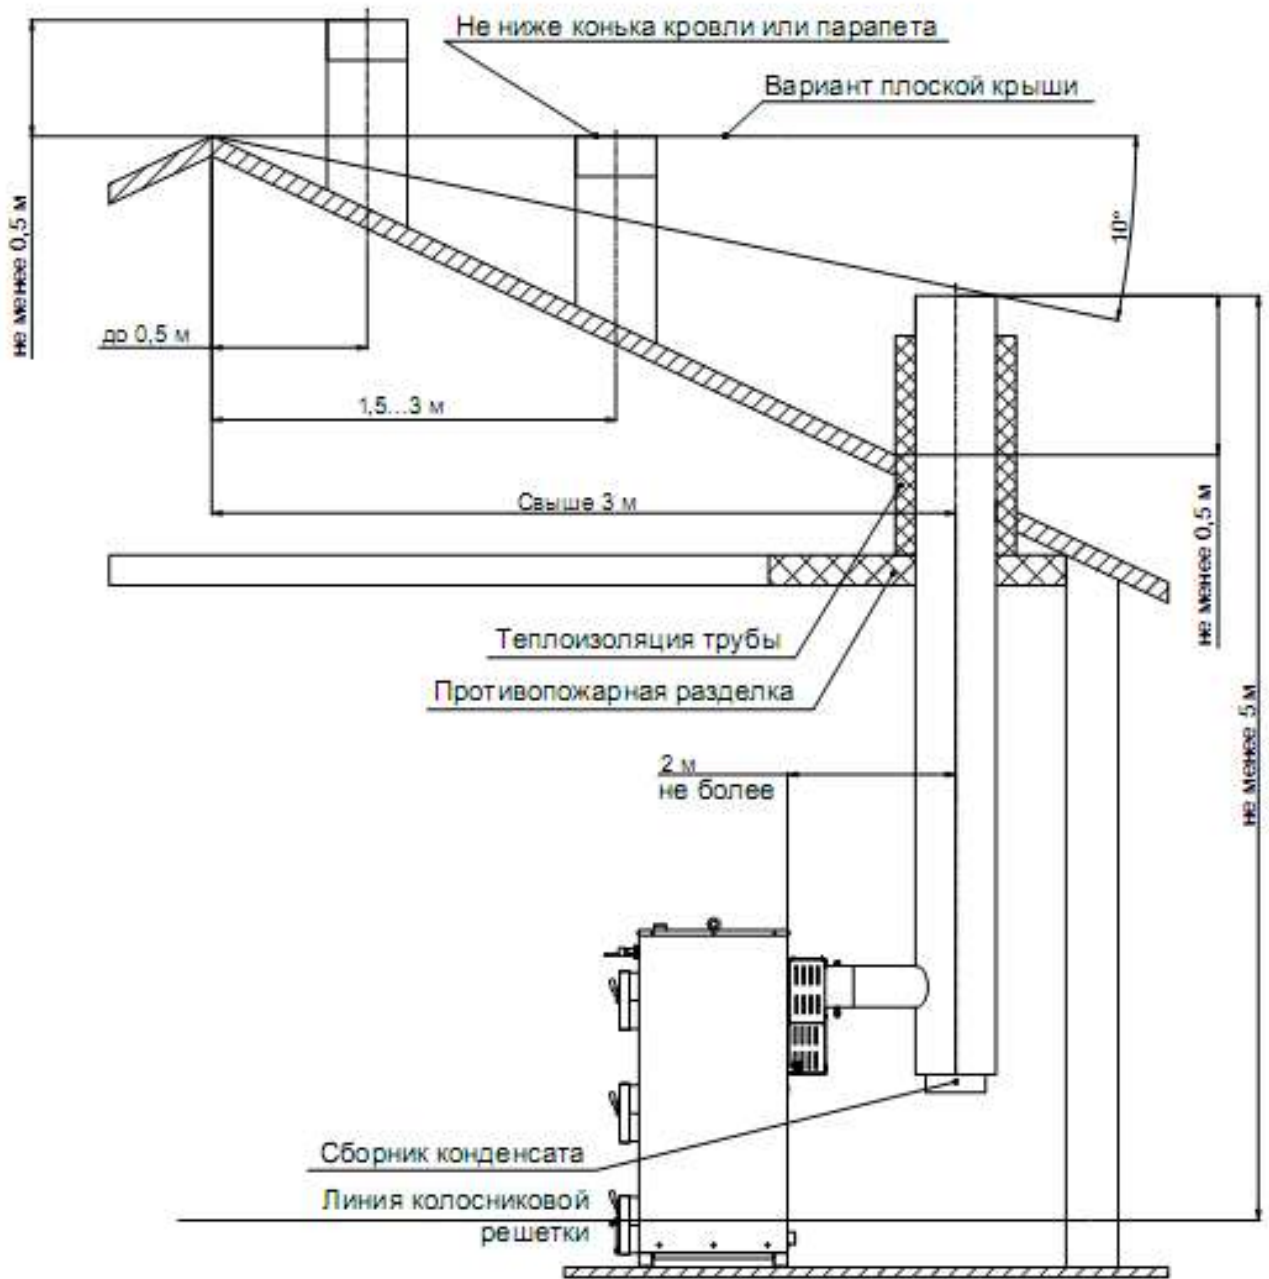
Схема установки трубы дымовой с выводом через потолочное перекрытие
